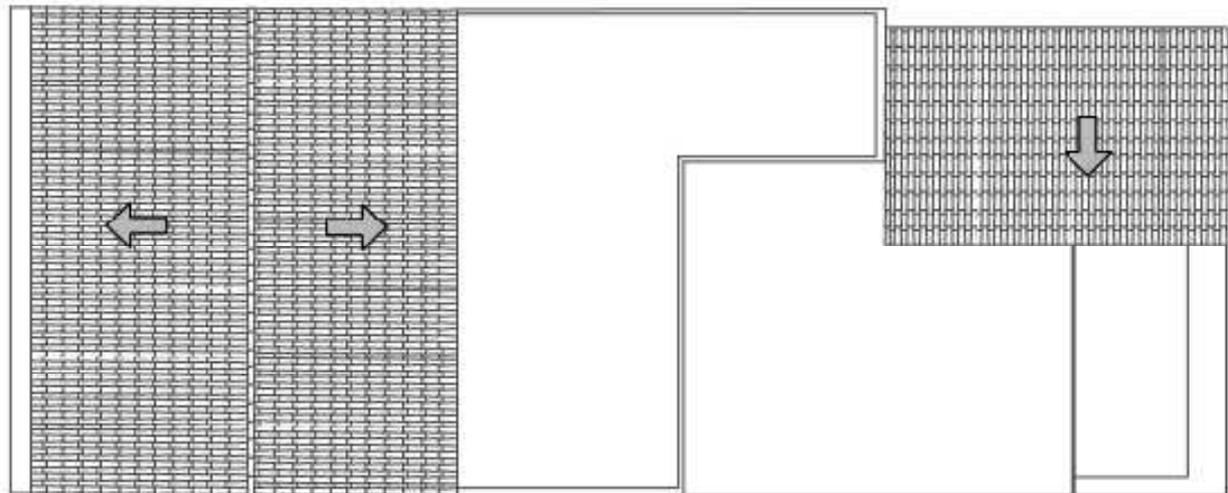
Distribución del estado actual de las cubiertas y azoteas de la vivienda . 2017. Fuente: propia
